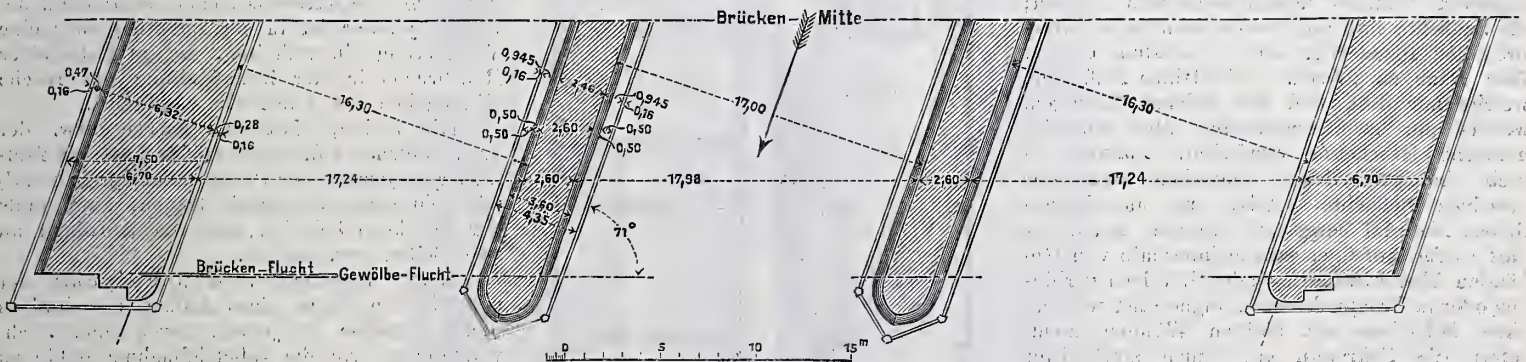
Grundriss in Höhe des Normalwassers (+30,48).
